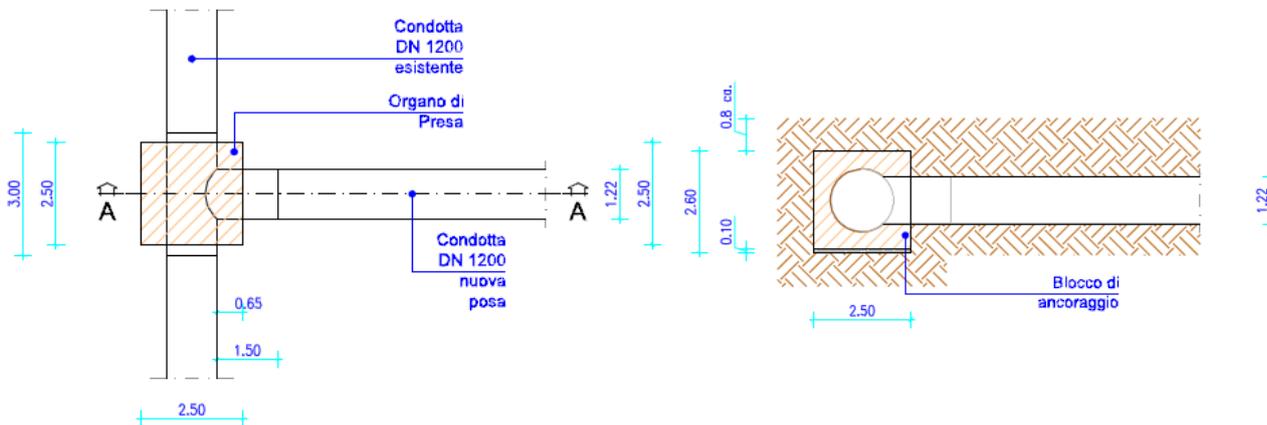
Organo di presa: particolari costruttivi della pianta (a sinistra) e della sezione (a destra)
